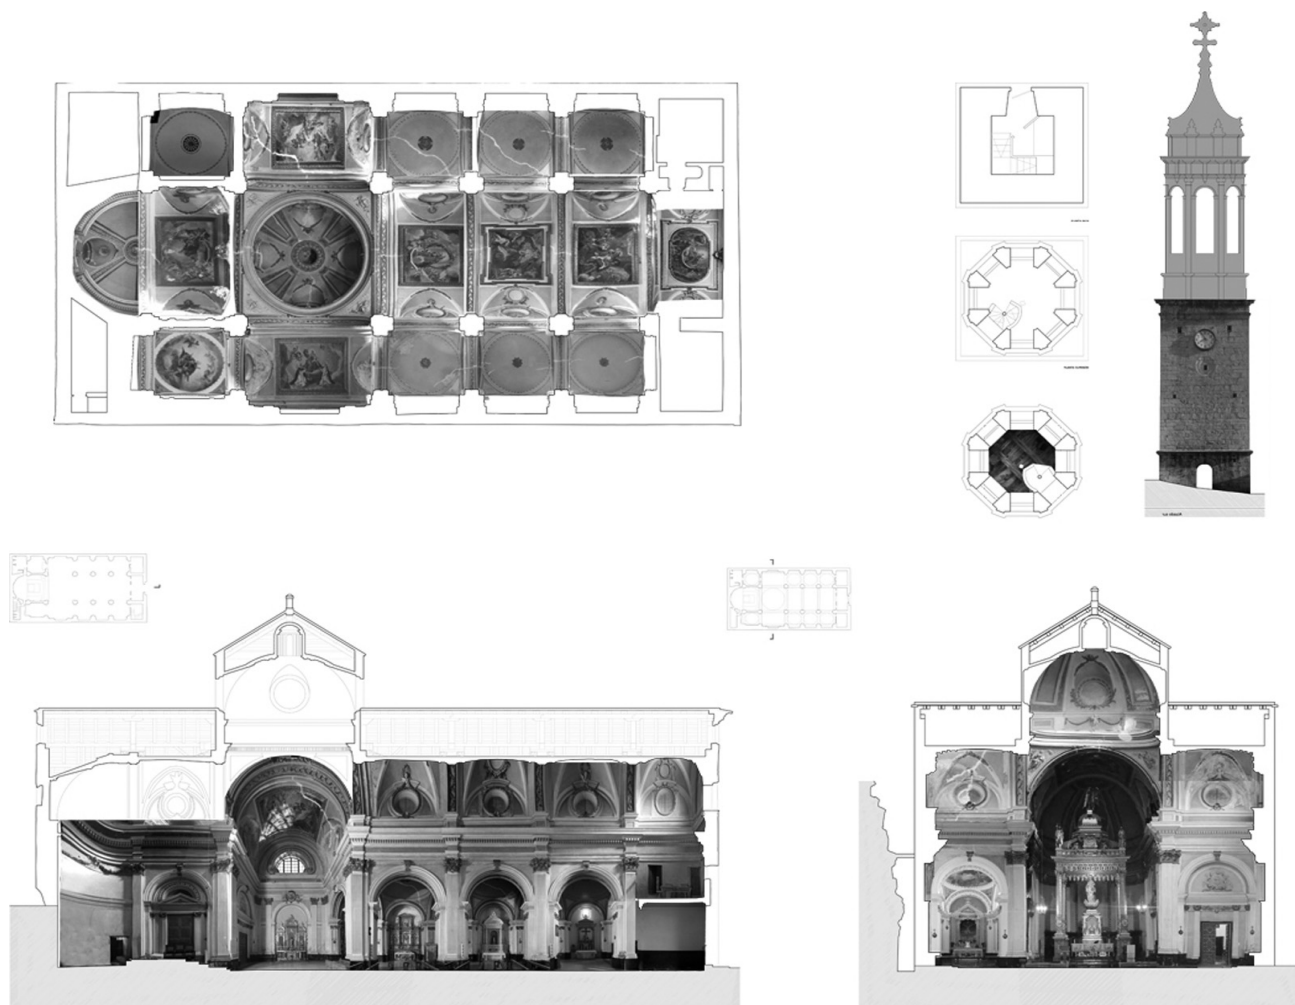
Fotoplanos de la planta y secciones de la iglesia y fotoplanos de las plantas y del alzado del reloj de la torre-campanario (Mileto & Vegas)
